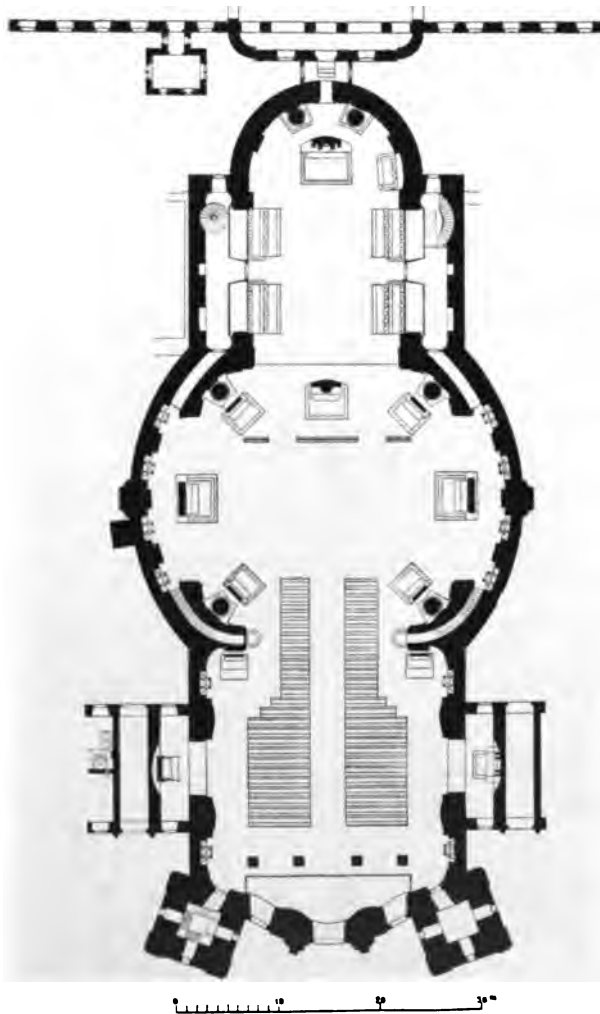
Grundriß der Klosterkirche zu Wiblingen
